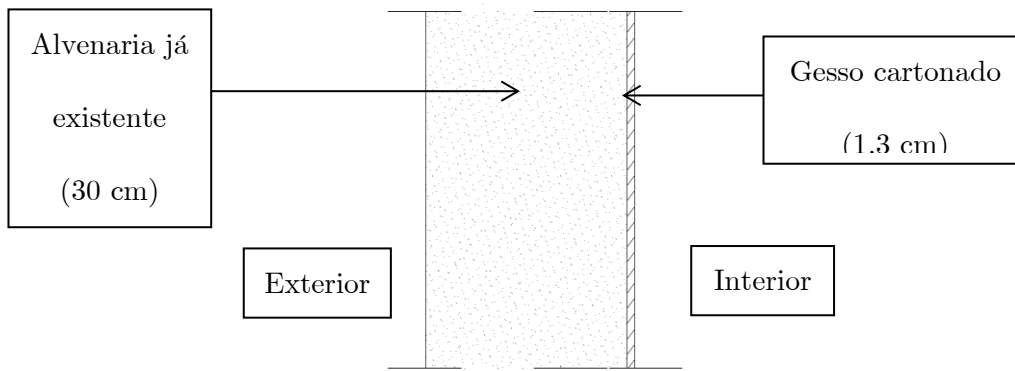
Pormenor construtivo da parede de separação do edifício adjacente
